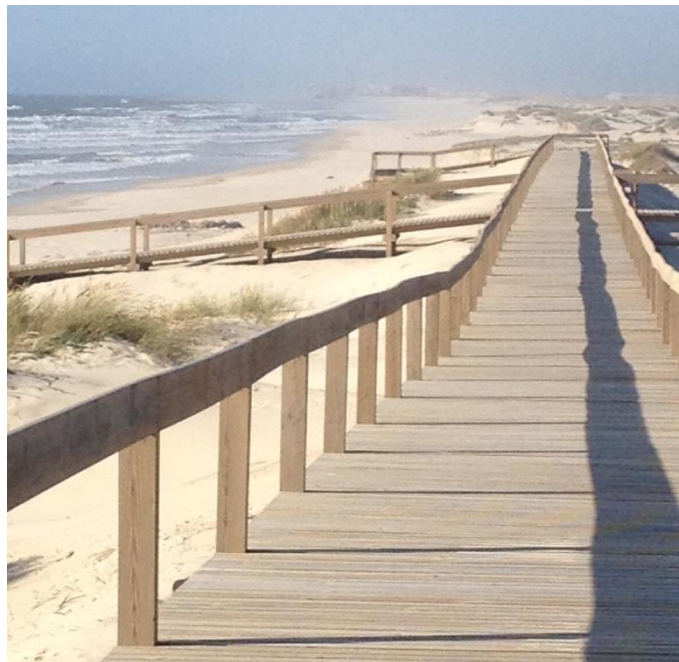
Passadiço existente na Praia do Areão (Junto à praia da Vagueira). Foto tirada em 02/05/2014
